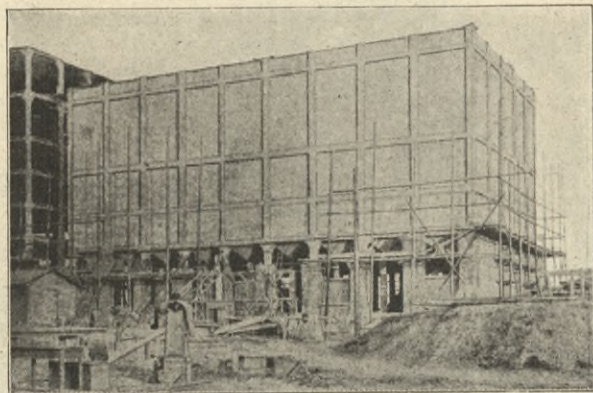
Chateau d'eau. Weltausstellung 1900.
